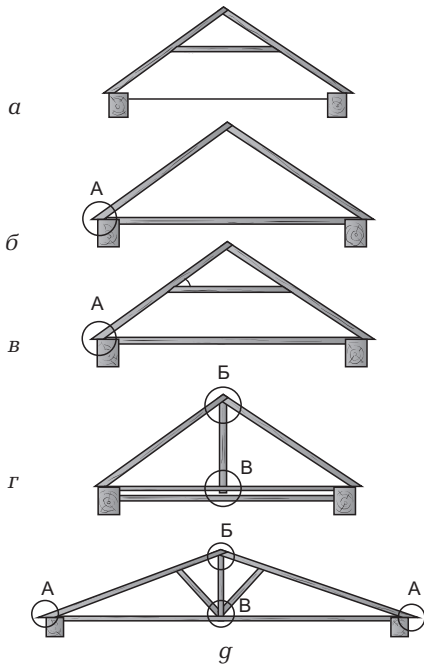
Схемы крыши с системой висячих стропил: а, б — для пролета до 8,0 м; в, г — для пролета до 9,0 м; г — для пролета до 12 м
